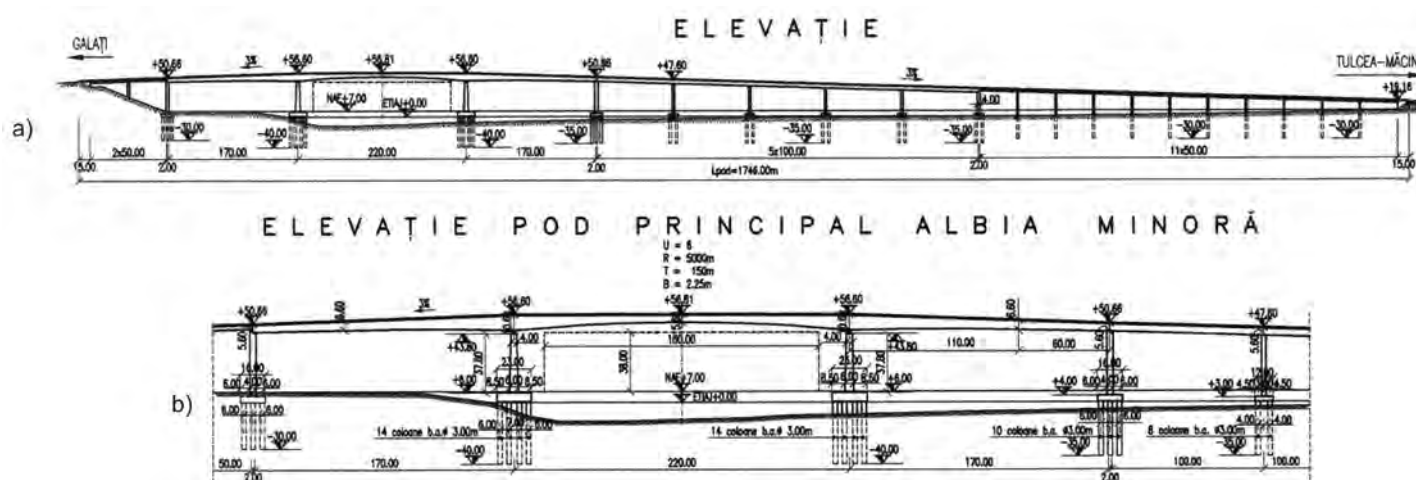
Dispoziție generală soluția cu grinzi continue cu placă din beton armat în conlucrare și soluția cu cadre continue din beton armat precomprimat cu execuție în consolă
